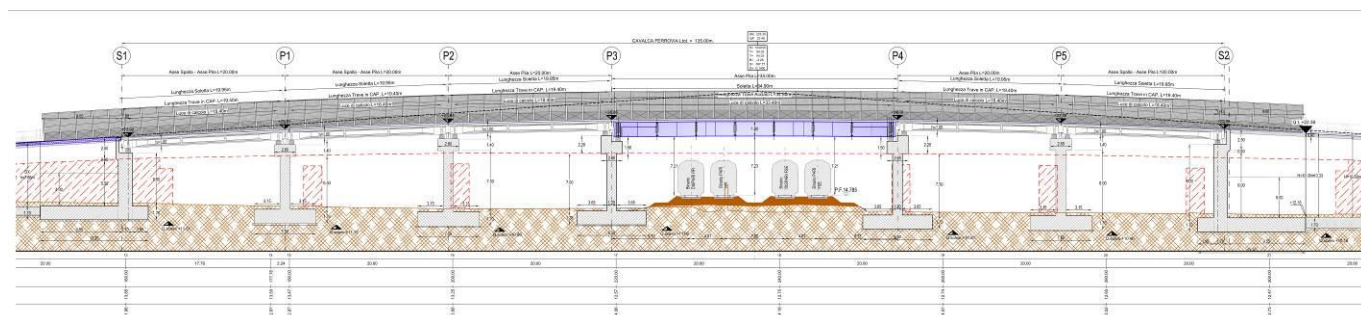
Prospetto e profilo impalcato del Cavalcaferrovia via Omodeo
